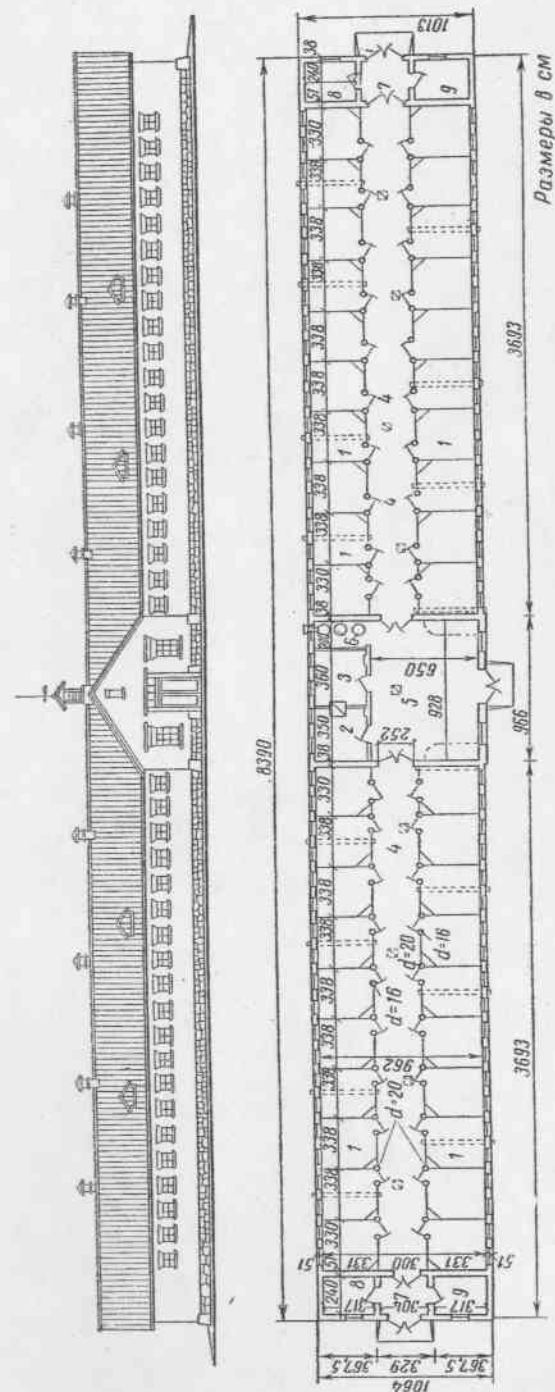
Конюшня на 40 голов тренировочного молодняка, стены кирпичные (фасад и план): 1—денники; 2—дежурная; 3—сбруйная; 4—проходы; 5—манеж; 6—площадка для воды; 7—тамбуры; 8—фуражные; 9—помещения для подстилки.
